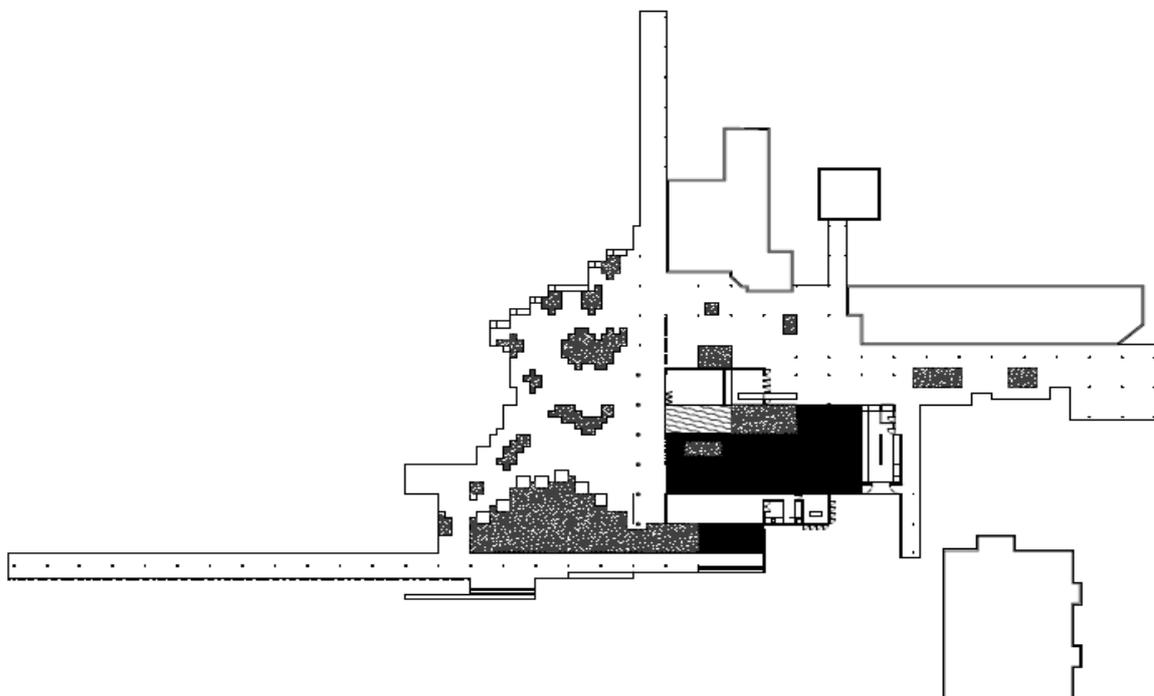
Conjunto proposto: planta térreo (FONTE: AGA KHAN AWARD, 2007)
